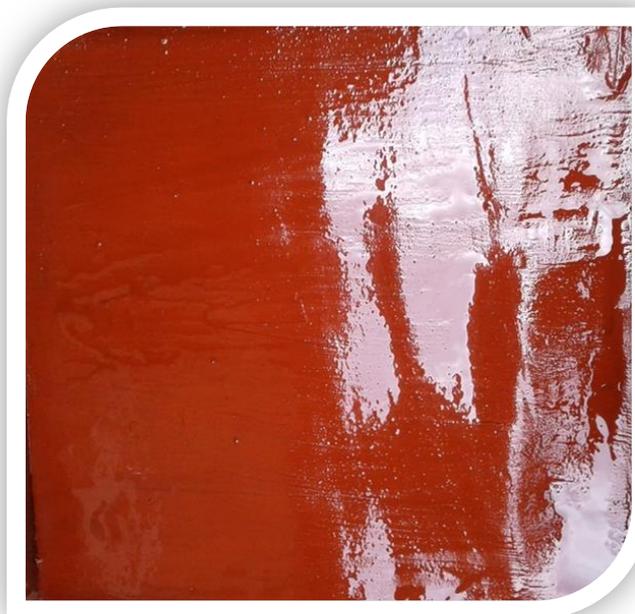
Piso Decorativo con Argamasa del Terreno y Cemento, Acabado Tipo Madera Oscura.
